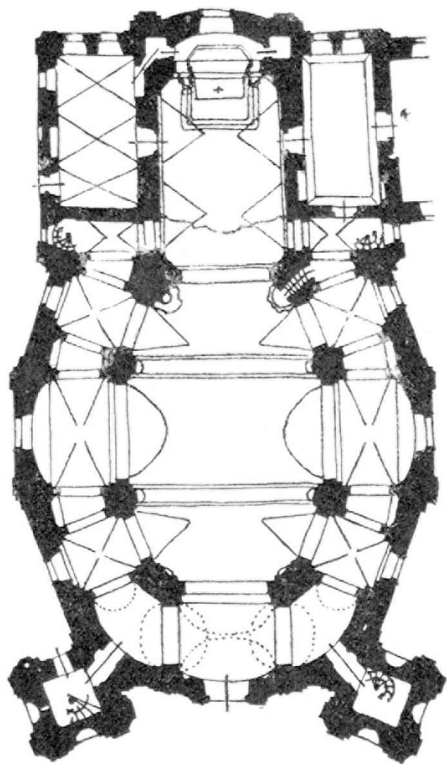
Plan kościoła po-paulińskiego we Włodawie, 1:400.
